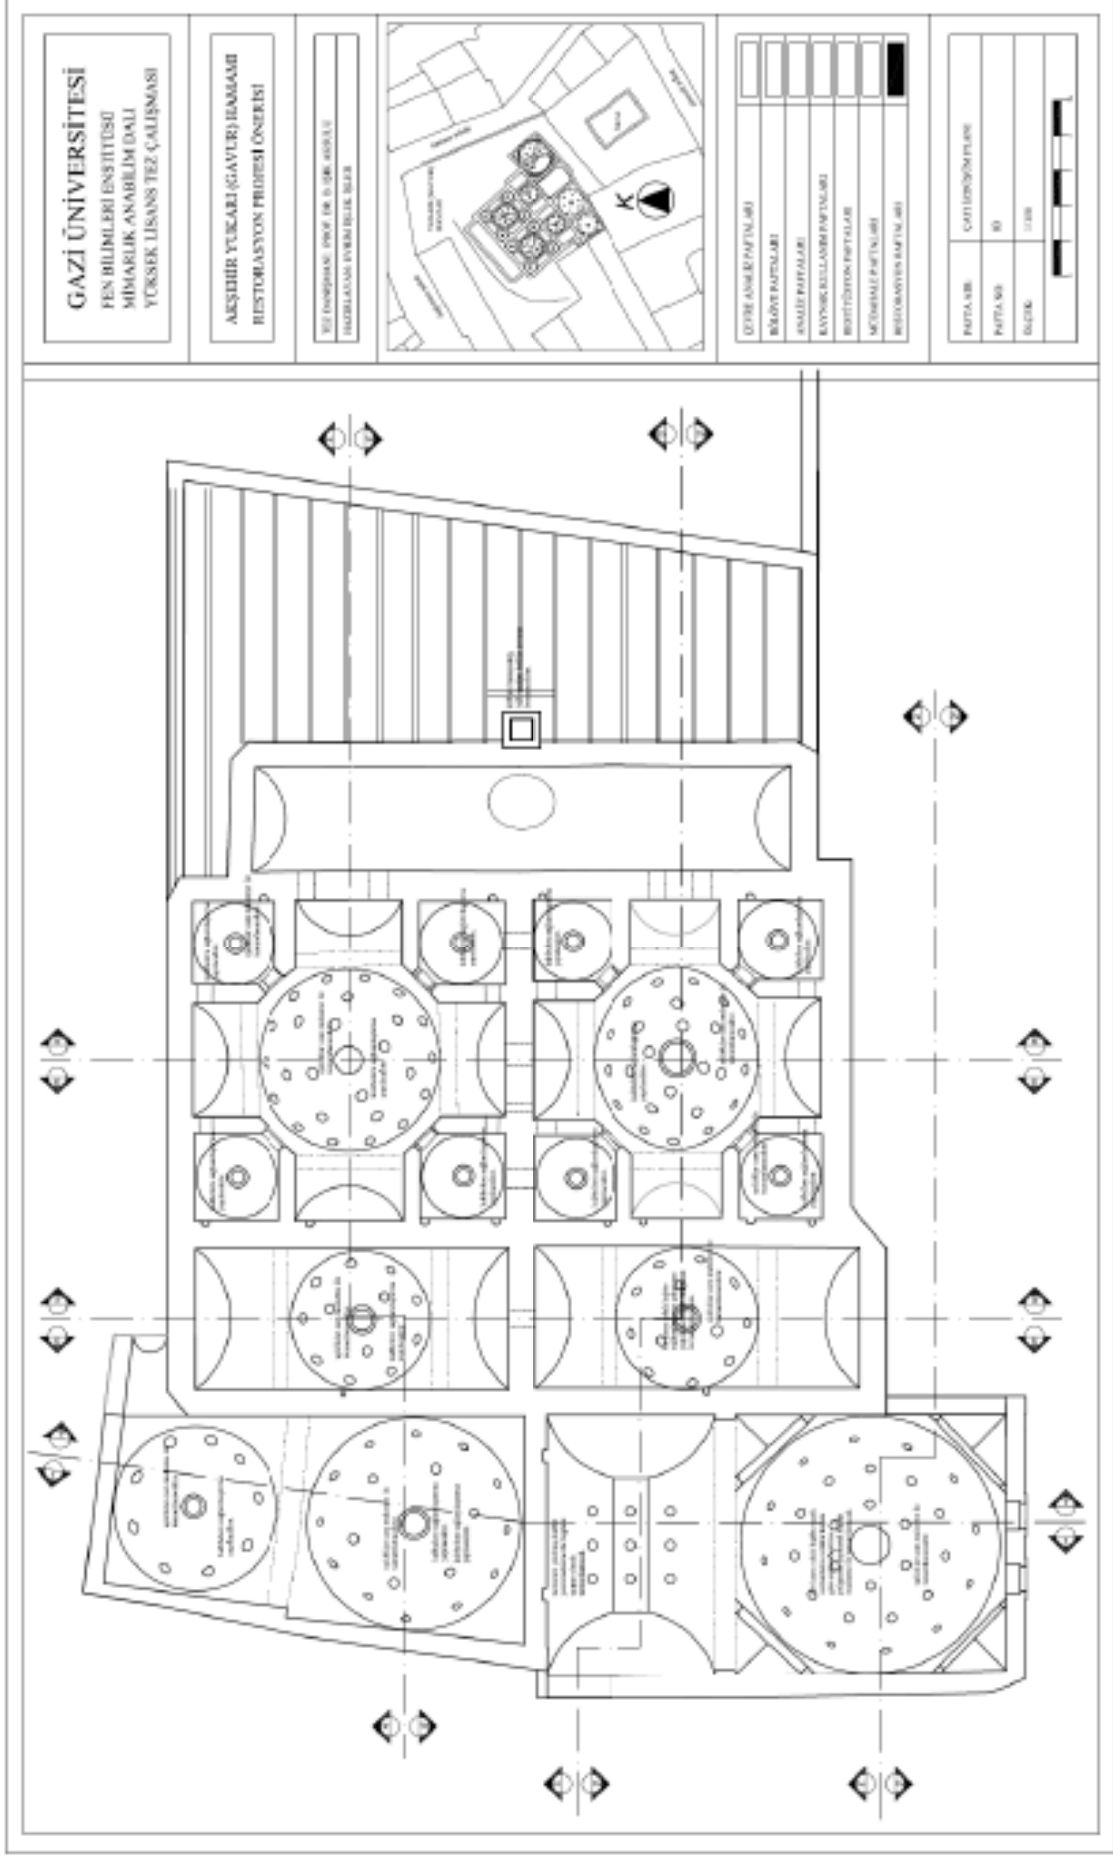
Yukarı (Gavur) Hamamı restorasyon planları vaziyet planı
